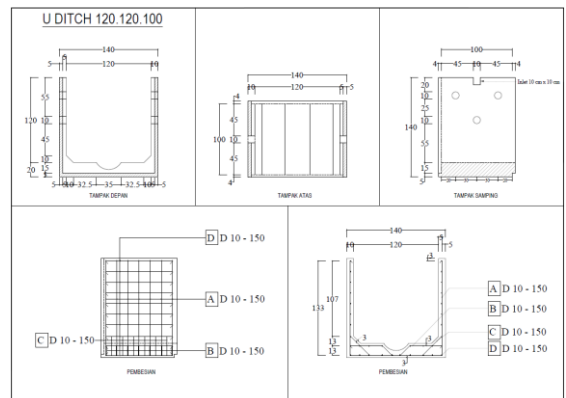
Potongan Melintang Drainase Eksisting Jalan Saudara Patok P28
